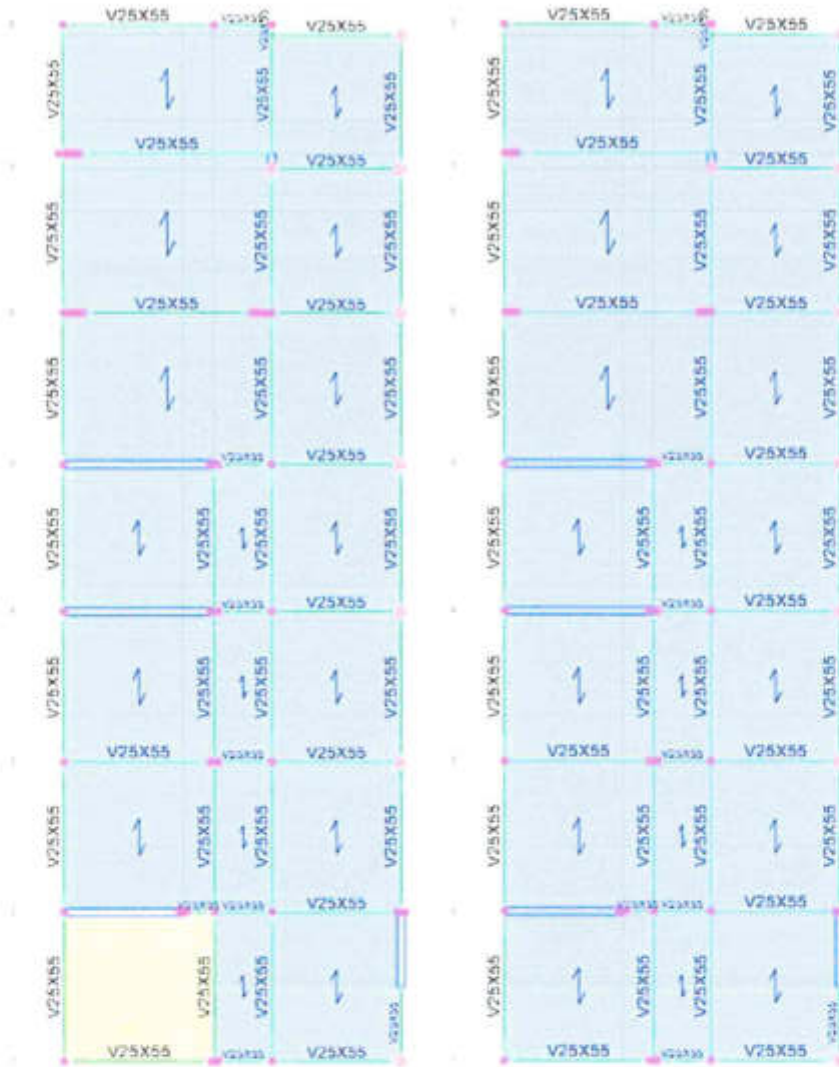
Planta Primer y segundo nivel con losa aligerada
